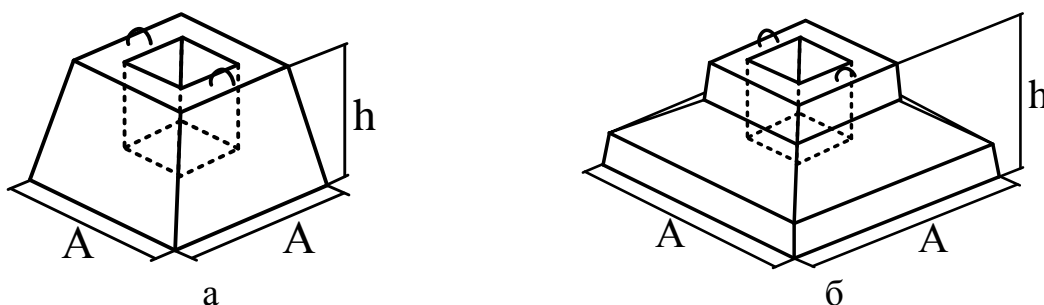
Фундаменты для колонн сечением $300\times 300\text{ м}$
